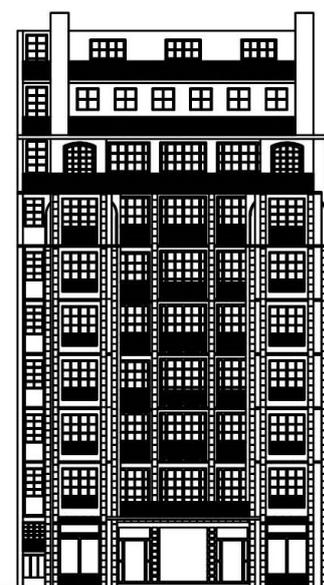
Prospetto casa Rue Franklin, Auguste Perret
